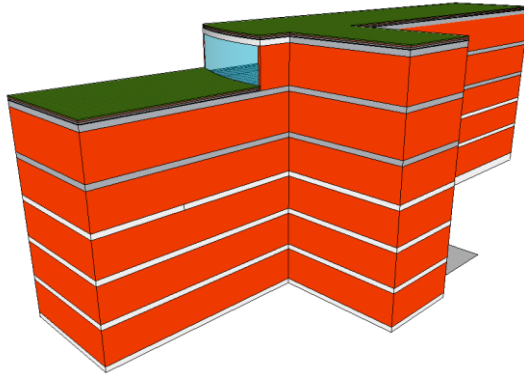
Muros externos del Edificio de Ingeniería Eléctrica.
